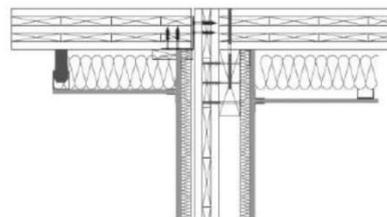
Appui de panneau de plancher sur pièce d'appui métallique ou bois
